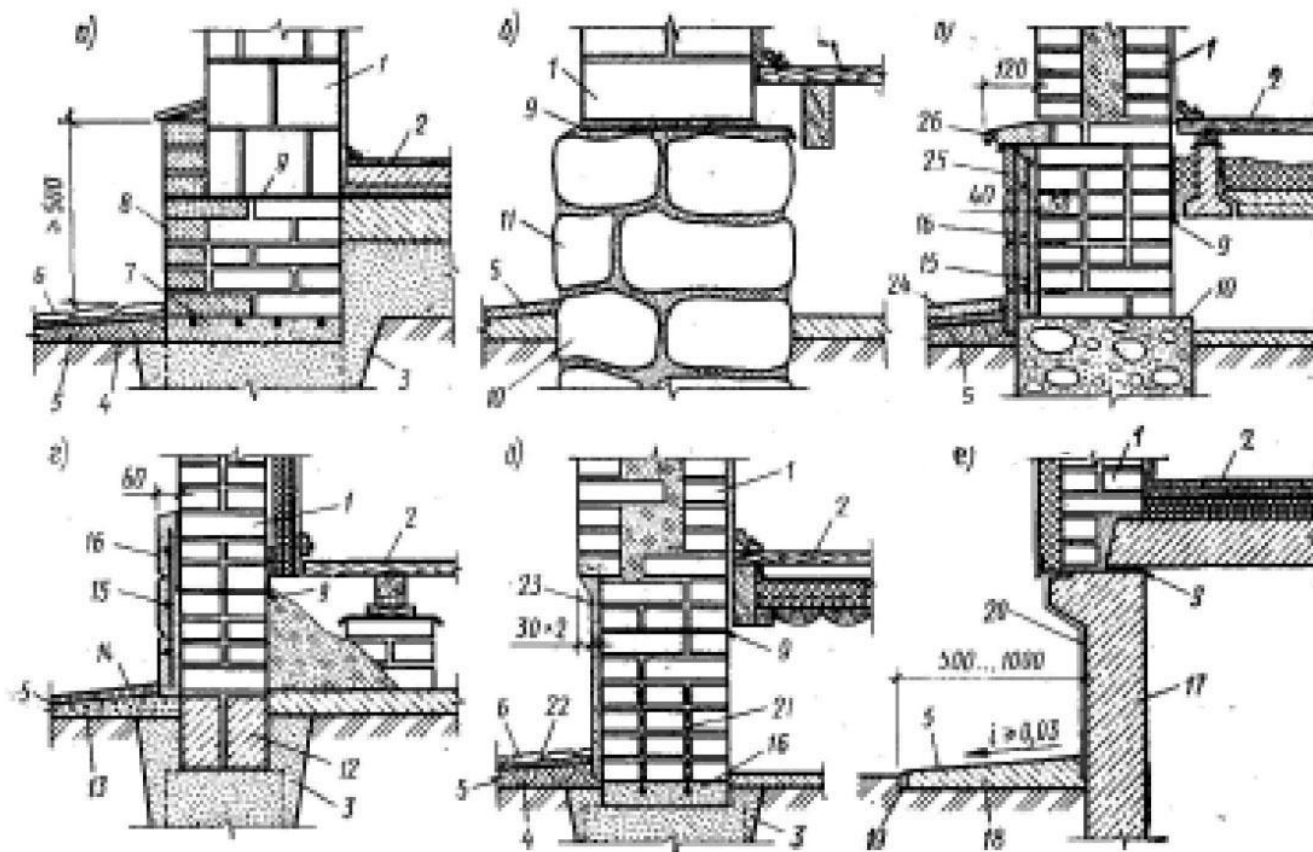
Цоколи каменных стен малоэтажных зданий:
